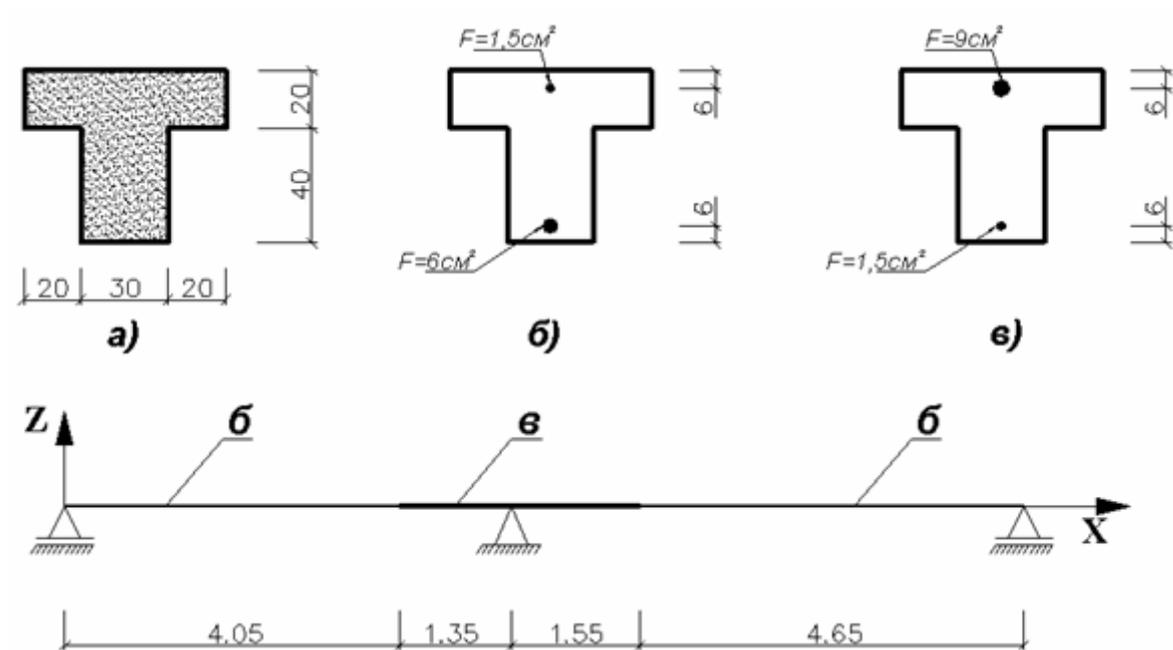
Сечения элементов балки: а) размеры сечения; б) пролетное сечение; в) опорное сечение
